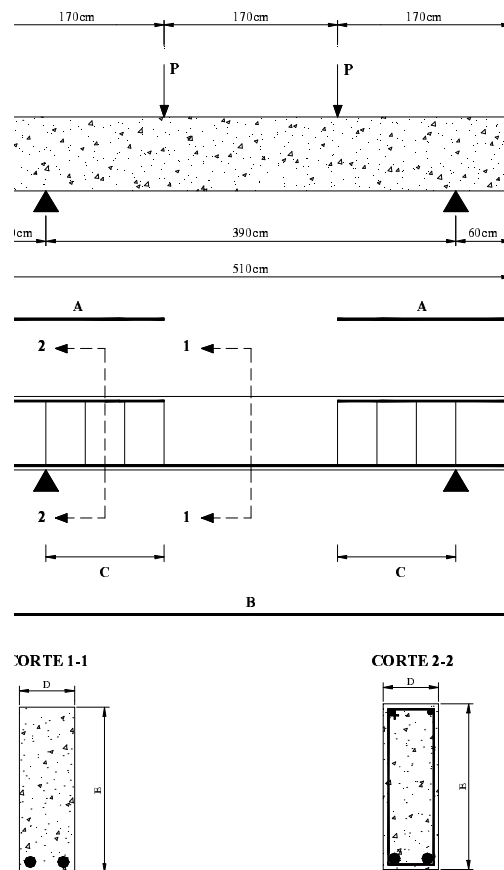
Detalhamento das vigas utilizadas nas modelagens
